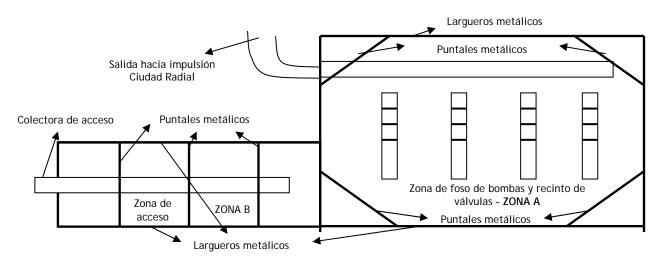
Vista en Planta de la Zona que debe llevar Apuntalamientos para Realizar las Excavaciones - Estación de Bombeo Ciudad Radial
